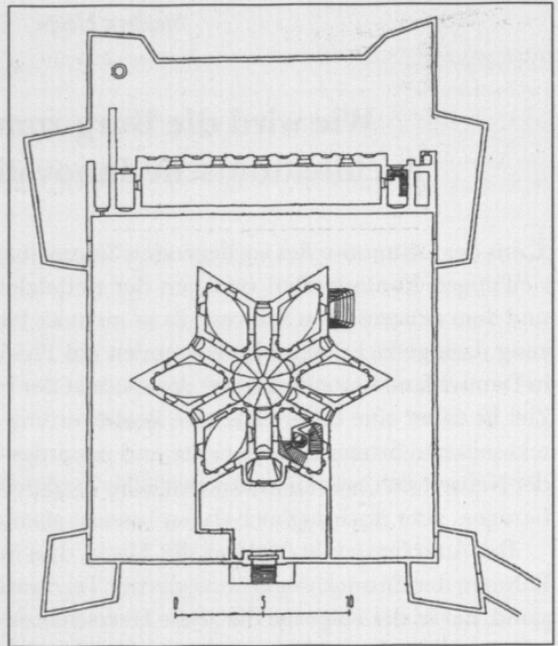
Schloss Stern bei Prag, erbaut ab 1555 nach dem Entwurf Erzherzog Ferdinands, Grundriss des Erdgeschosses.
